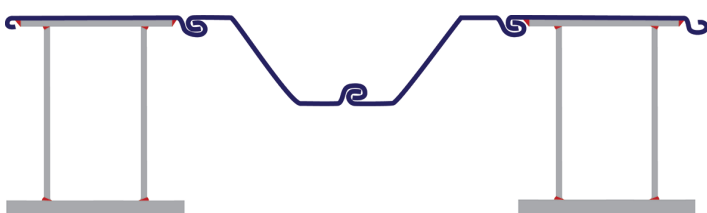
Несущая свая в виде разнотолщинного разнополочного сварного балочного короба с х/к ПФЗ
